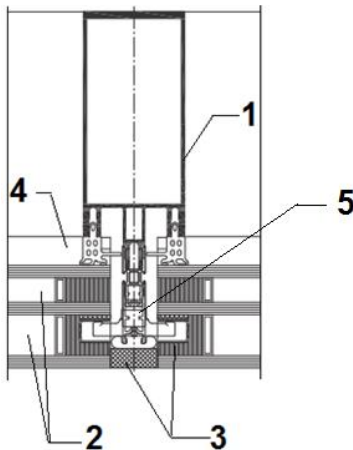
Przekrój przez słupek ściany elementowej.
